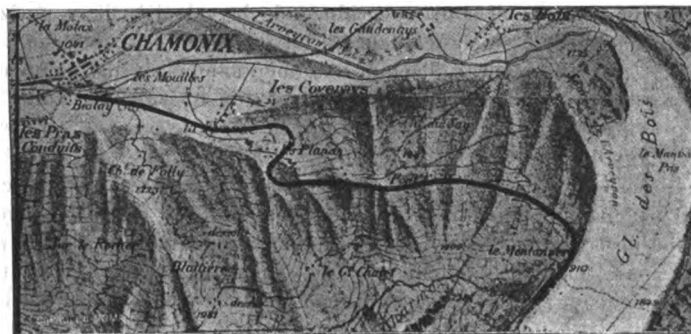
Ferrovia Chamonix-Montenvers. - Planimetria generale.
